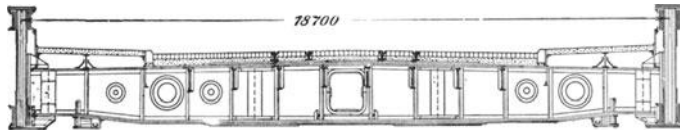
Lagerung der Rohre auf einer eisernen Straßenbrücke.
